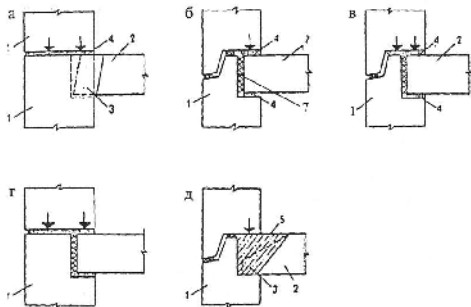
Горизонтальные стыки панелей всухих наружных стен и схемы передачи в них вертикальной нагрузки: а – контактный; б – пластформный; в – комбинированный профилированный; в – то же, плоский; д – монолитный; 1 – панель наружной стены; 2 – панель перекрытия; 3 – опорный "палец" панели перекрытия; 4 – цементный раствор; 5 – бетон замоноличивания; 6 – угловая прокладка; 7 – утепляющий вкладыш
